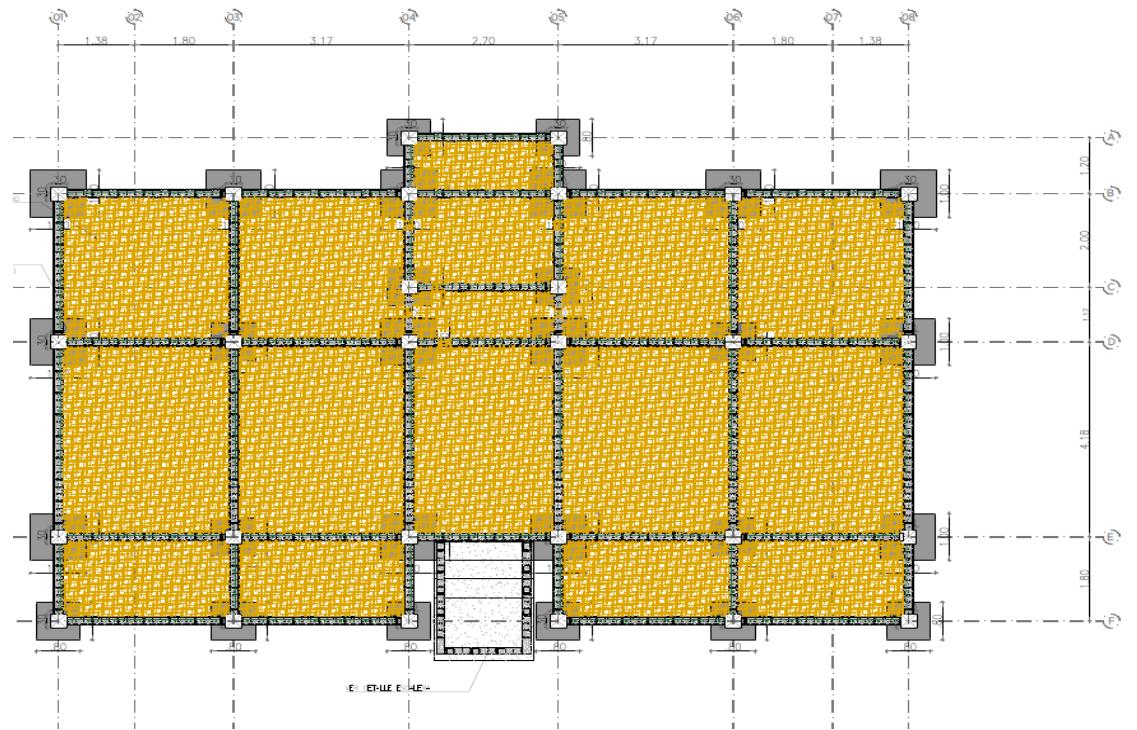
Intercesión en planta de cimientos paredes y detalle típico de vigas de amarres. Para mayor detalle ver Anexo 14.11.
